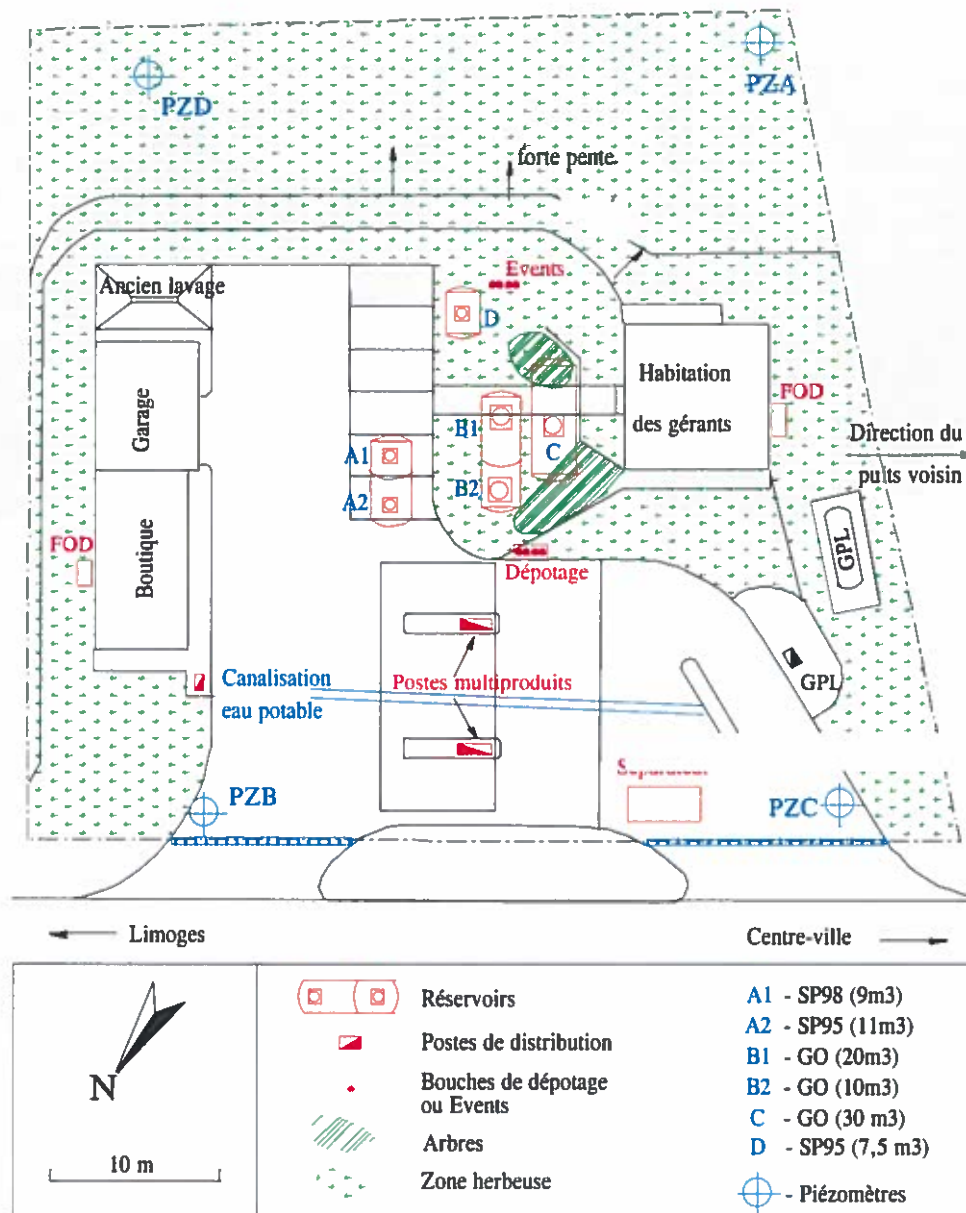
Plan d'implantation des piézomètres colmatés par AMDE
